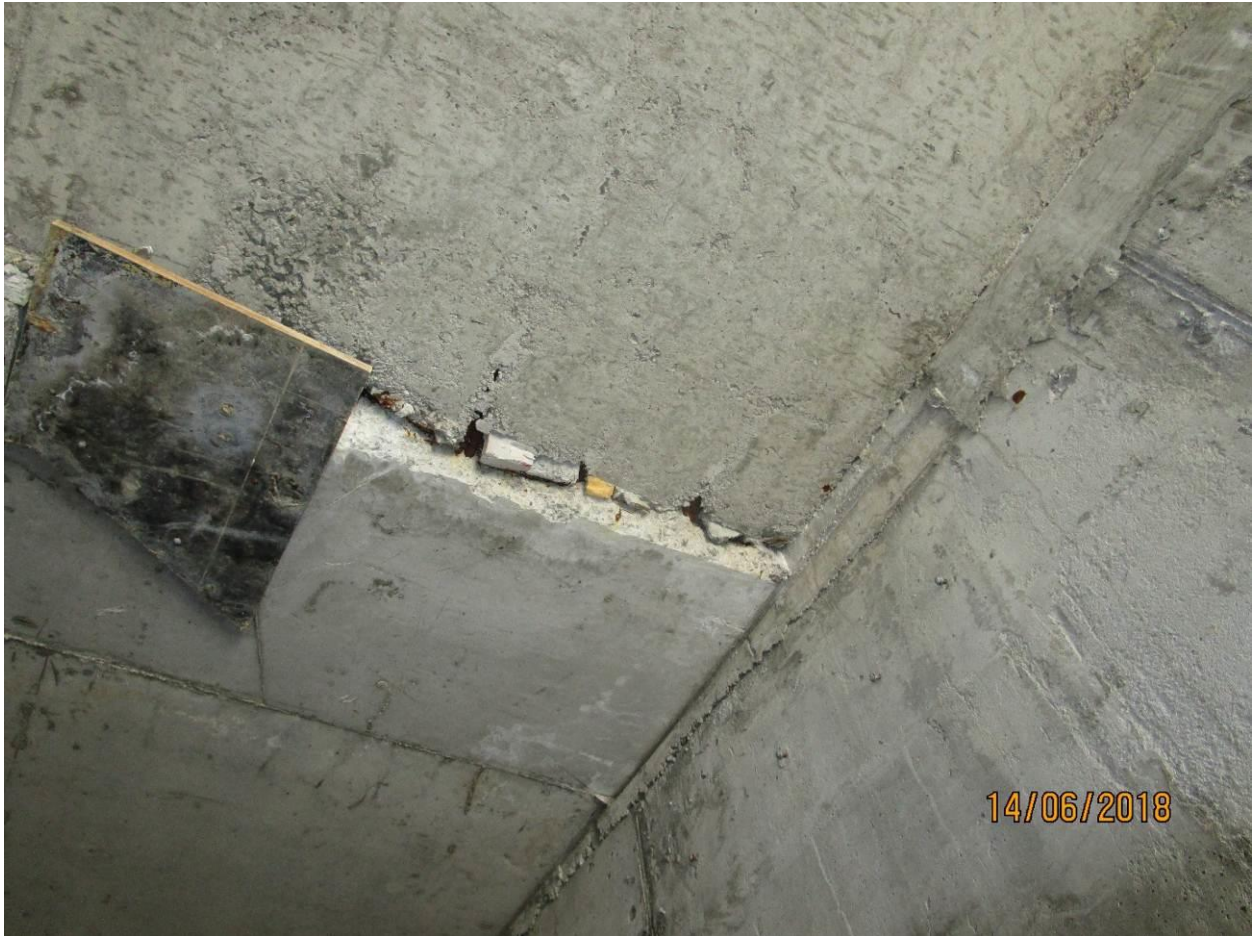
В конструкции плиты перекрытия в осях АИ/А7-А8 15 эт. выполнен холодный шов бетонирования заполненный строительным мусором с отсутствием заполнения бетона.
